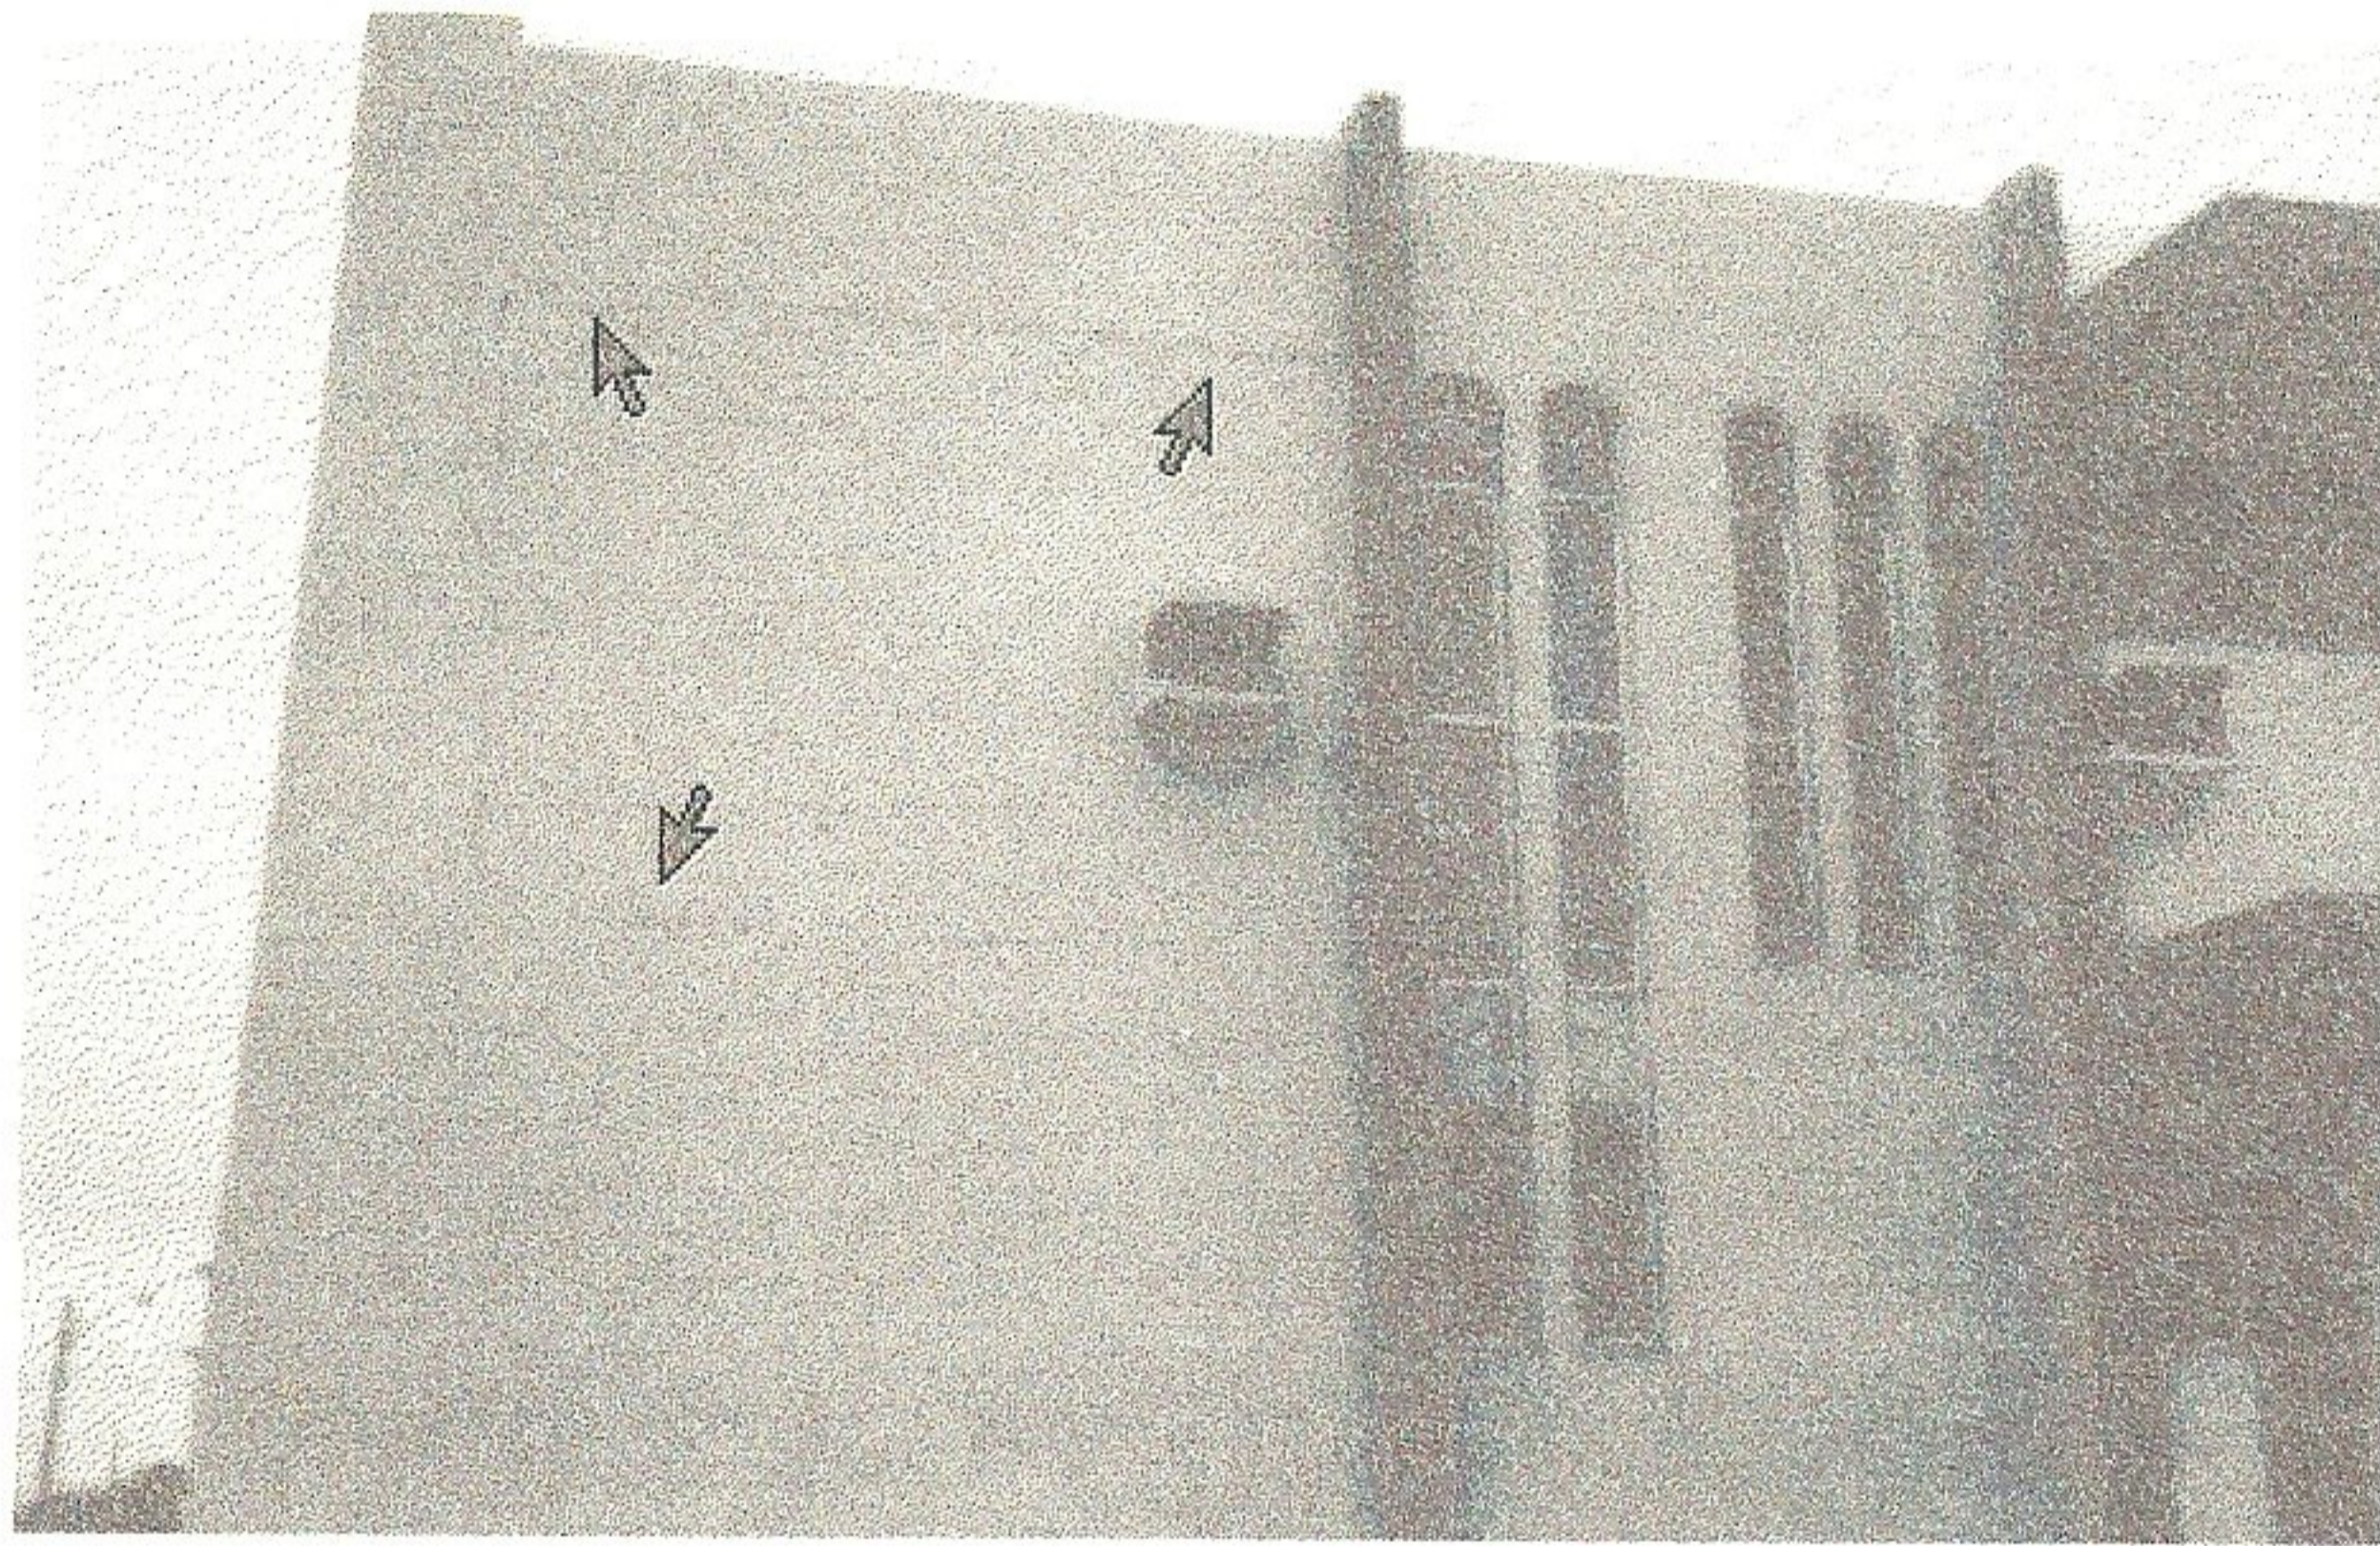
Fissuras de cisalhamento provocadas por expansão térmica da laje de cobertura. [22]
